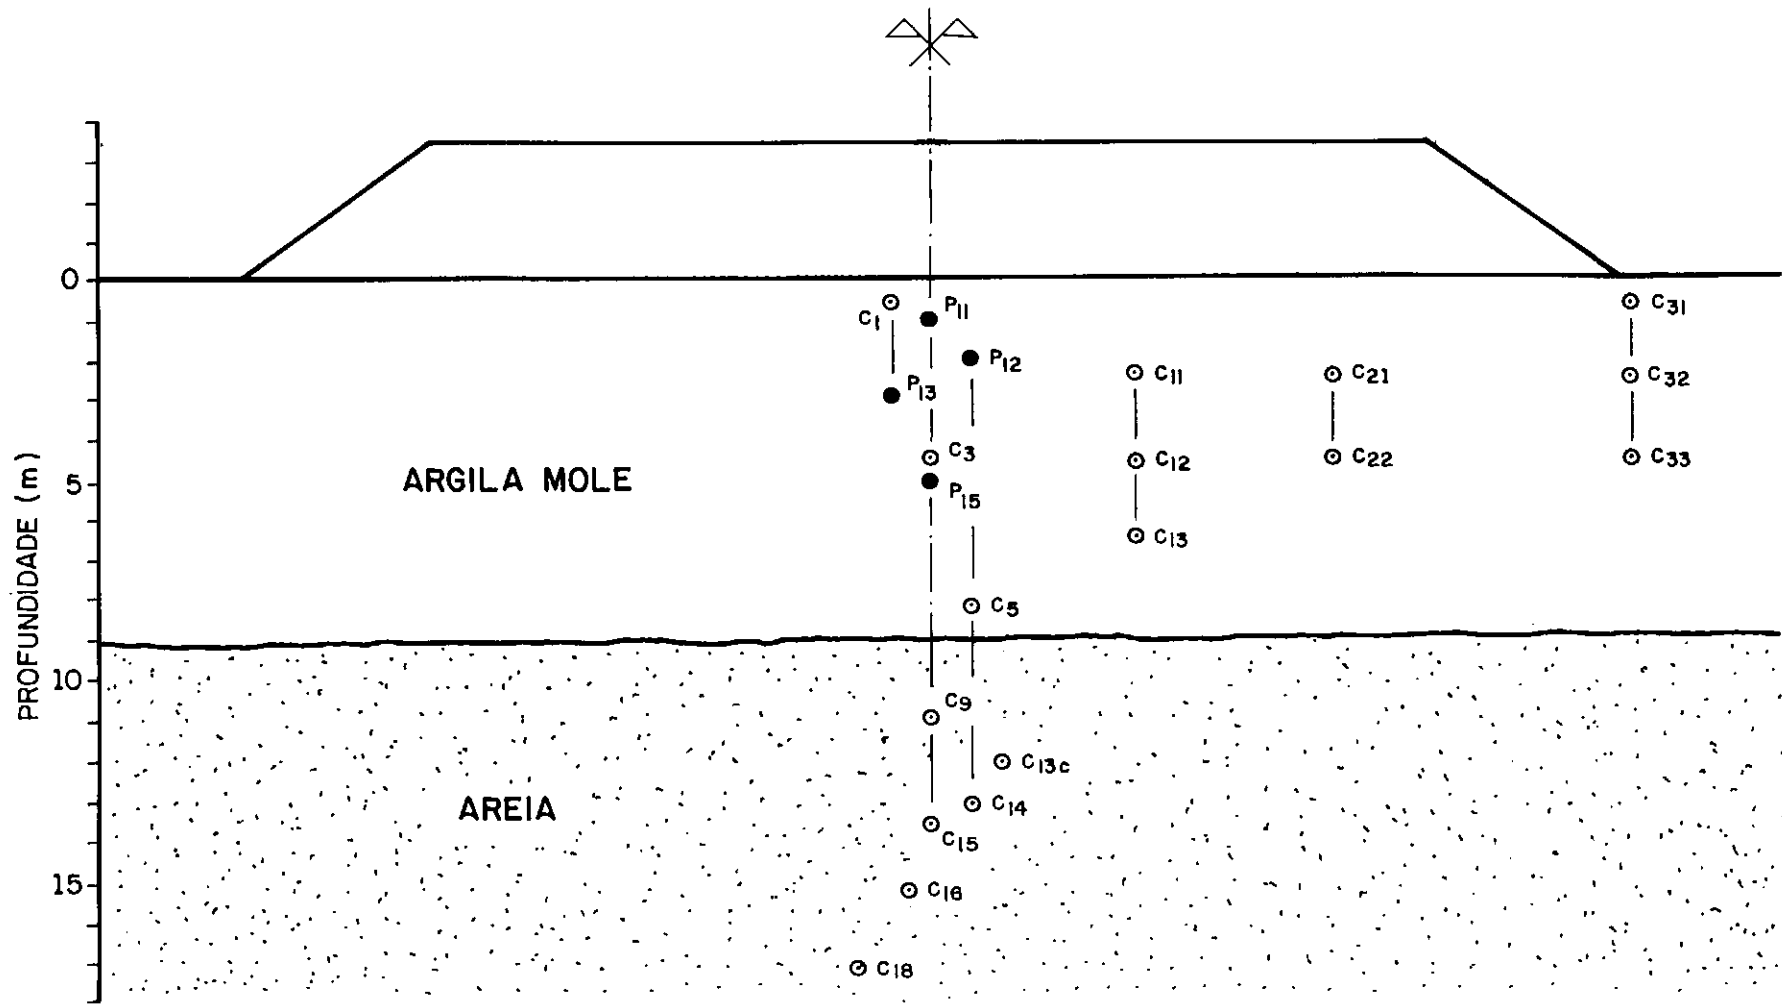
Planta Típica da Localização dos Piezômetros na Seção G.
